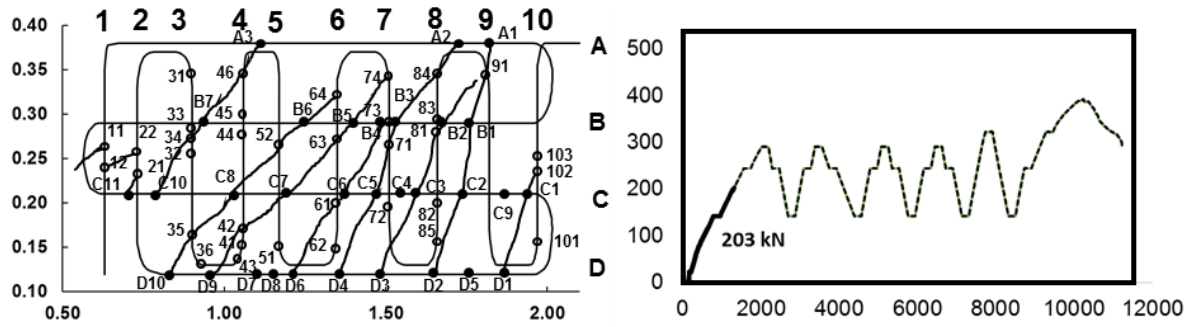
Patrones de fisuración de la viga I-2 (203 a 260 kN)
